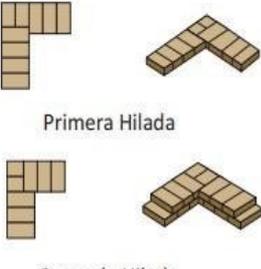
Estructura típica de la Mampostería de Adobe (Frontal y Perfil)
